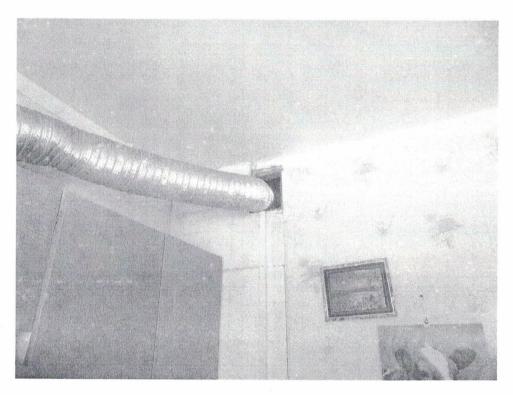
Фрагмент жилой комнаты. Третий этаж квартира №52. Следы увлажнений на перекрытии в углу у окна.
